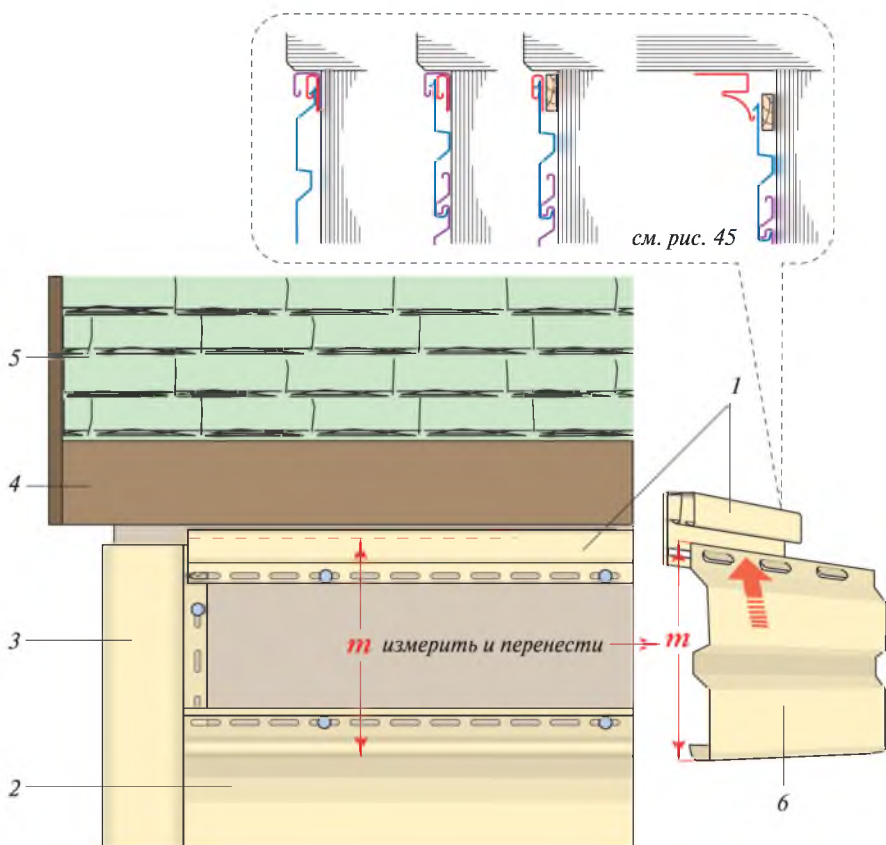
Установка сайдинга на «зацепах» под карнизом или соффитом: 1 — завершающие профили (финишный профиль на выравнивающей рейке или внутри J-профиля (или наличника), либо молдинг Дёске); 2 — рядовая сайдинговая панель; 3 — угловой профиль; 4 — карниз; 5 — крыша; 6 — подкарнизная (резаная) сайдинговая панель с зацепами
